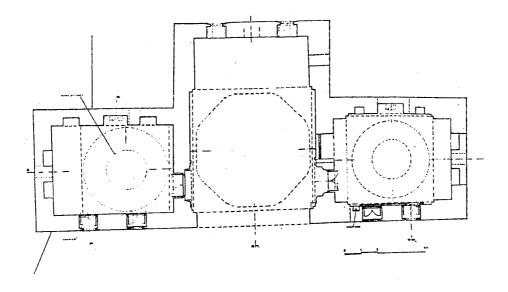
مسقط أفقي لجامع اسحاق باشا في إينه كول . (عن : Kuran).
